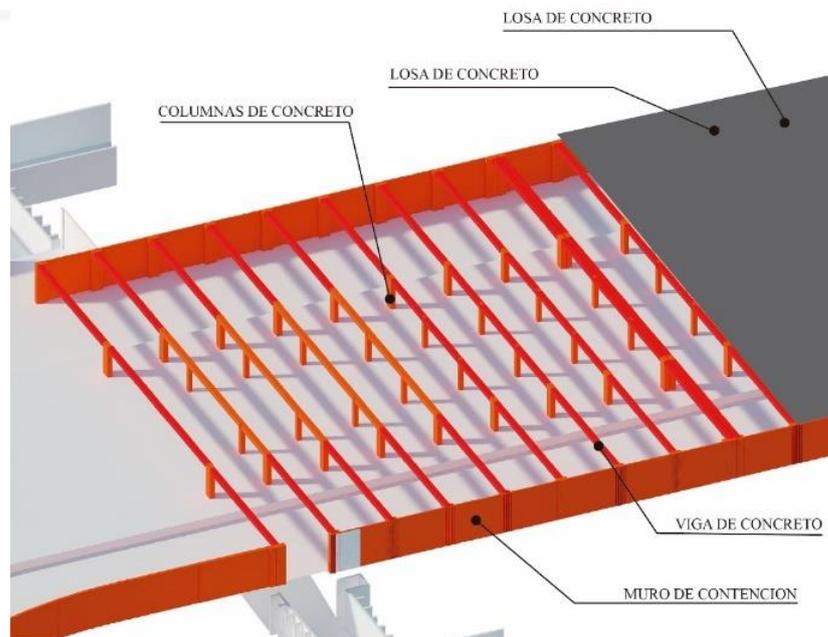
Muros, columnas y vigas de la Estación Central del Metropolitano
